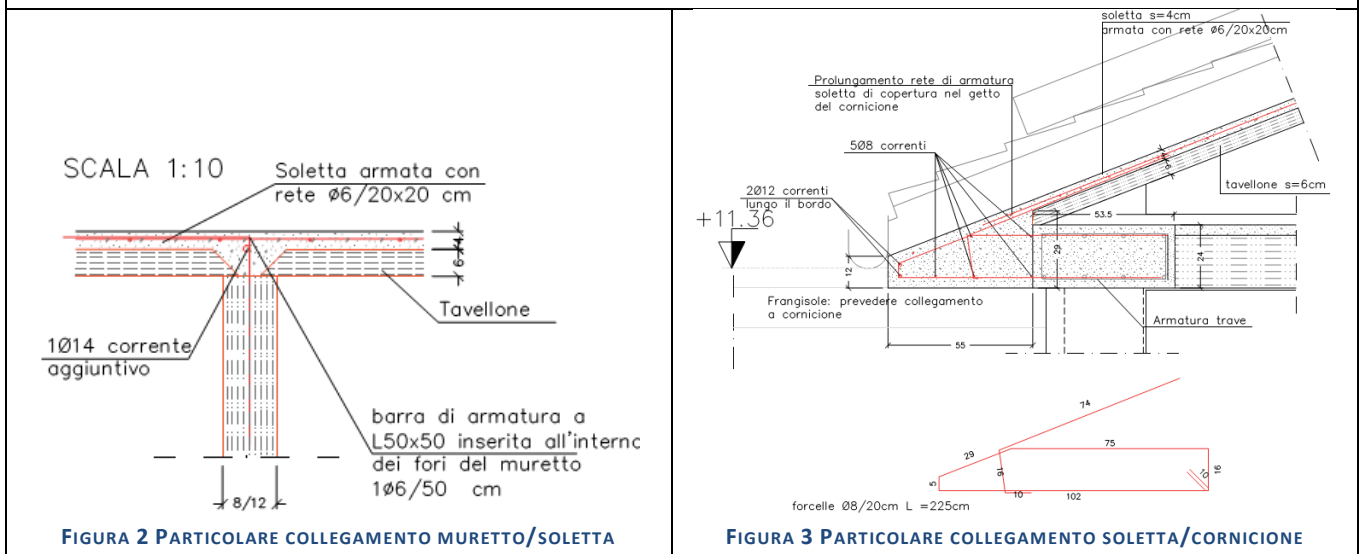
PARTICOLARE COLLEGAMENTO MURETTO/SOLETTA
